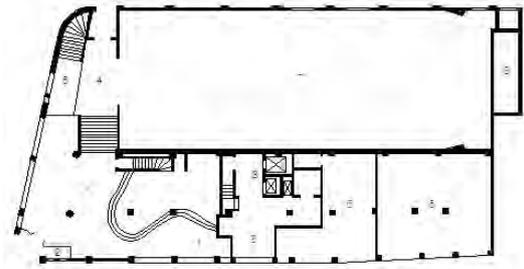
Edifício Vera Cruz, planta do pavimento térreo. Fonte: Arquivo Municipal da Prefeitura de Porto Alegre. Filme 082, Processo 13494/39. Redesenhado pela autora conforme plantas originais.
